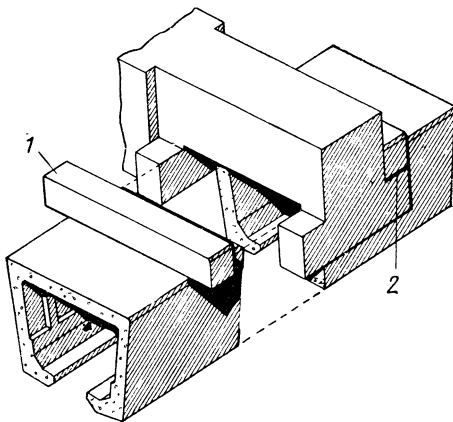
Способ крепления секций ходовой балки к опорной стойке:
